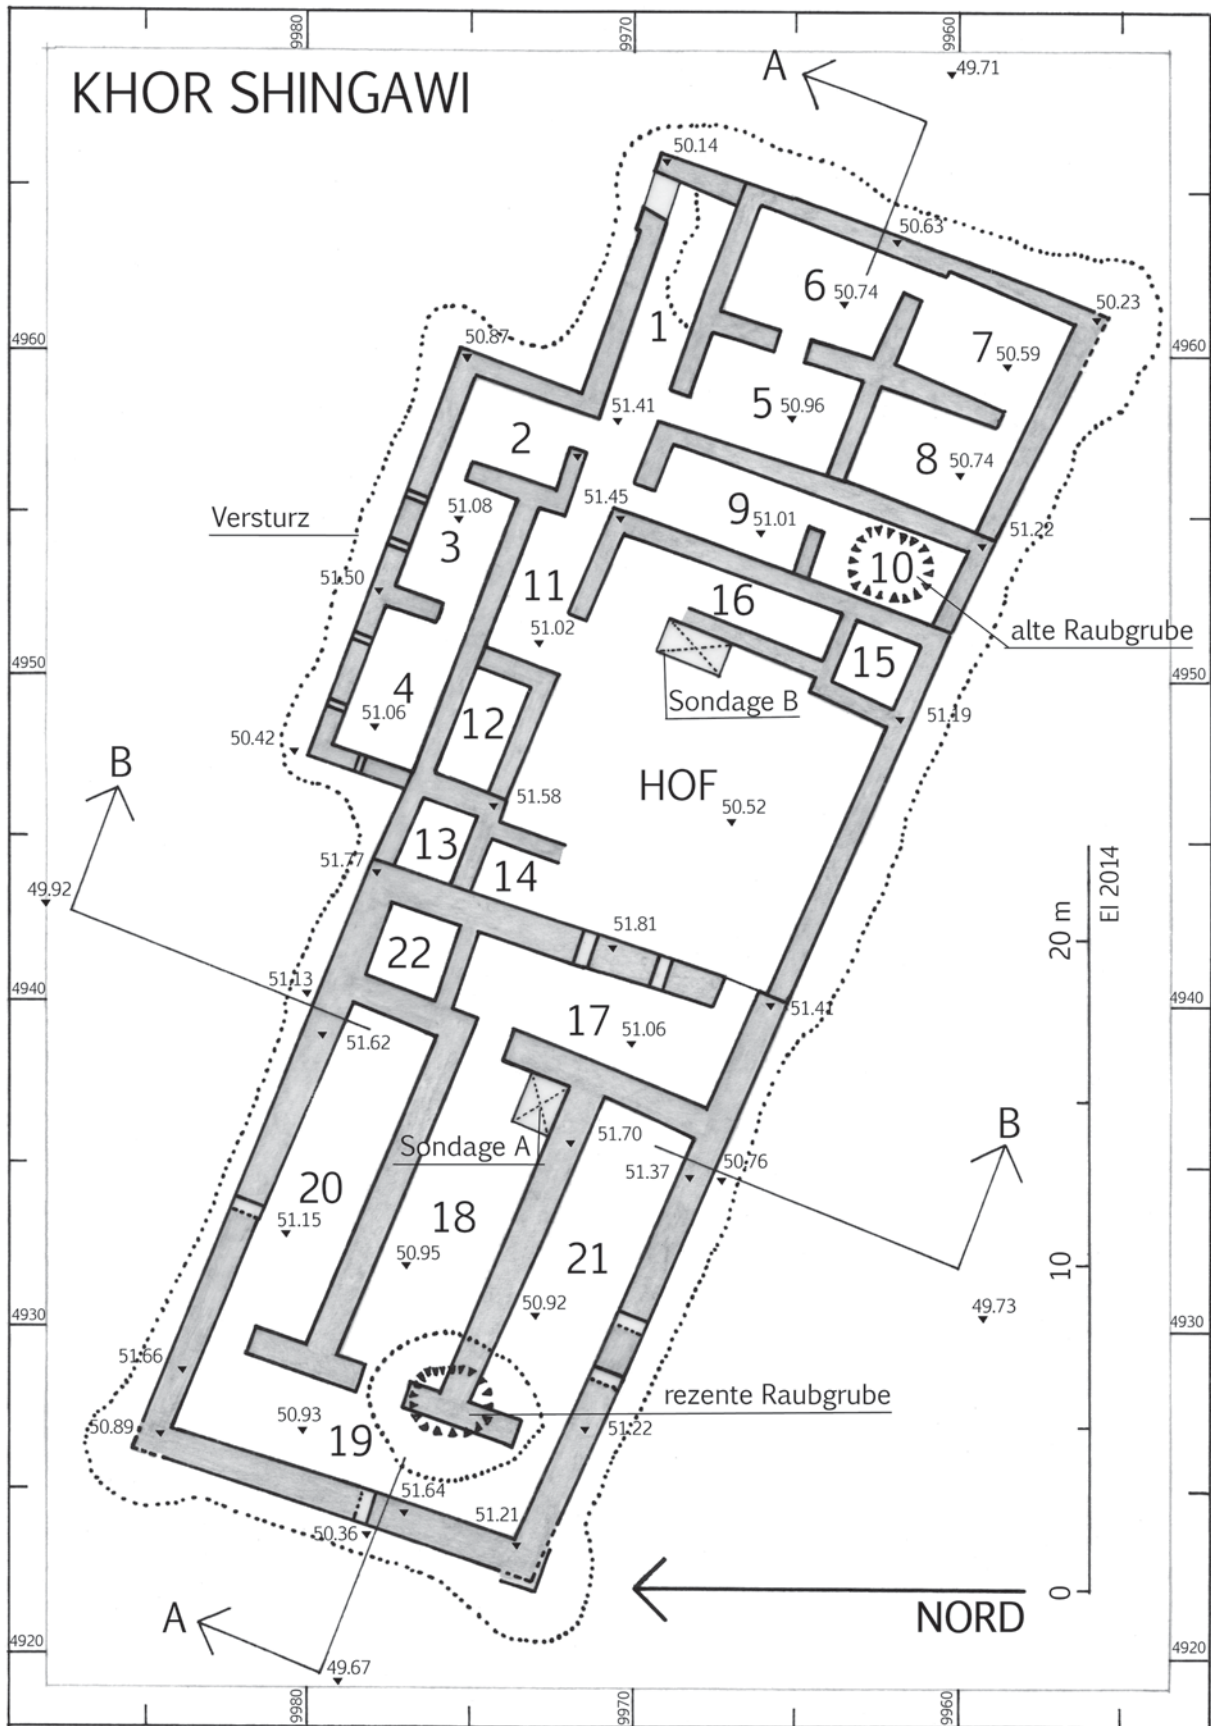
Grundrissplan der Ruine im Khor Shingawi. (Feldaufnahme und Umzeichnung: D. Eigner & T. Karberg).
